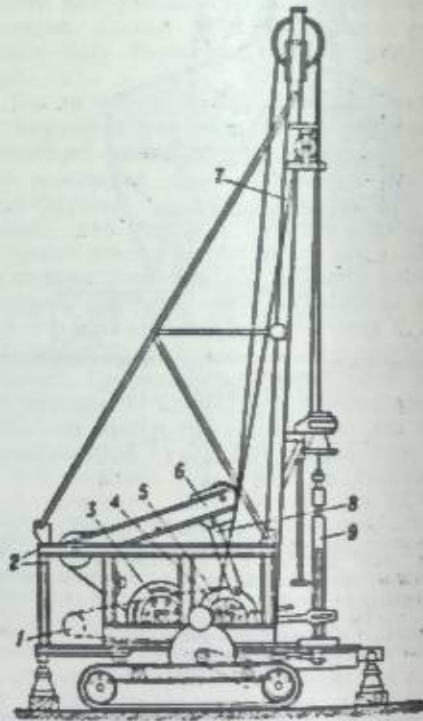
Буровой станок ударно-канатного бурения: 1 — двигатель; 2 — рама; 3 — подъемный барабан; 4 — желоночный барабан; 5 — балансирующая шестерня долбежного устройства; 6 — балансир долбежного устройства; 7 — мачта; 8 — шатун долбежного устройства; 9 — буровой снаряд.
